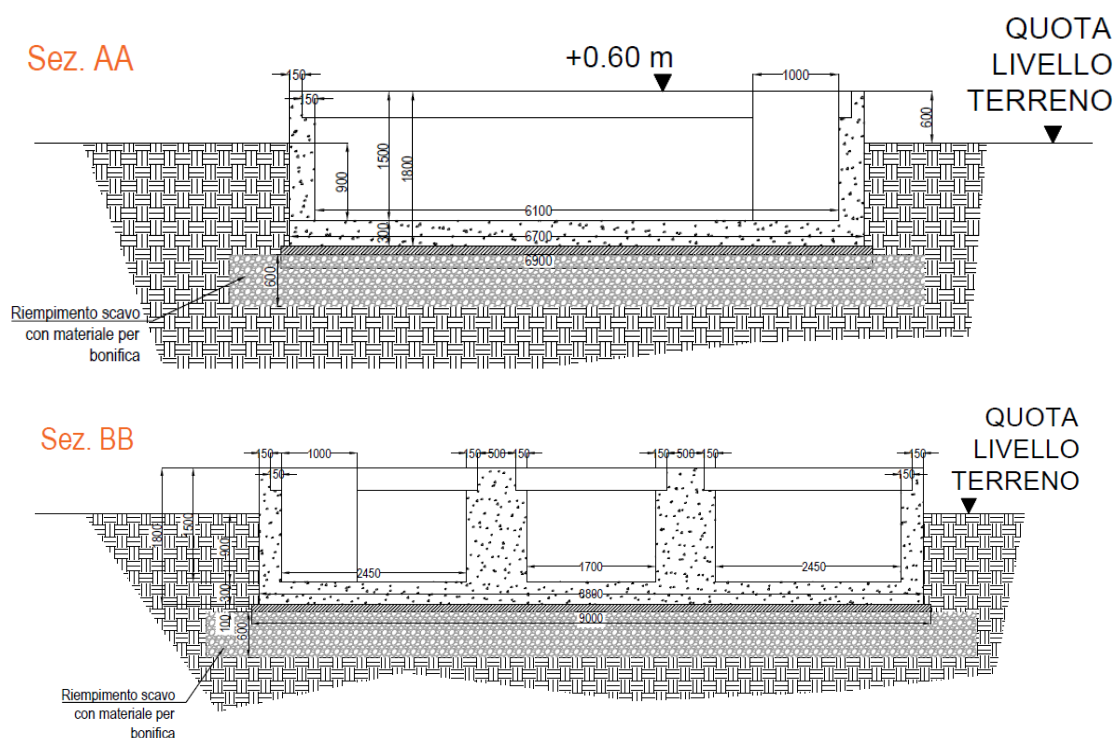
Sezioni vasca di fondazione trasformatore SSE
